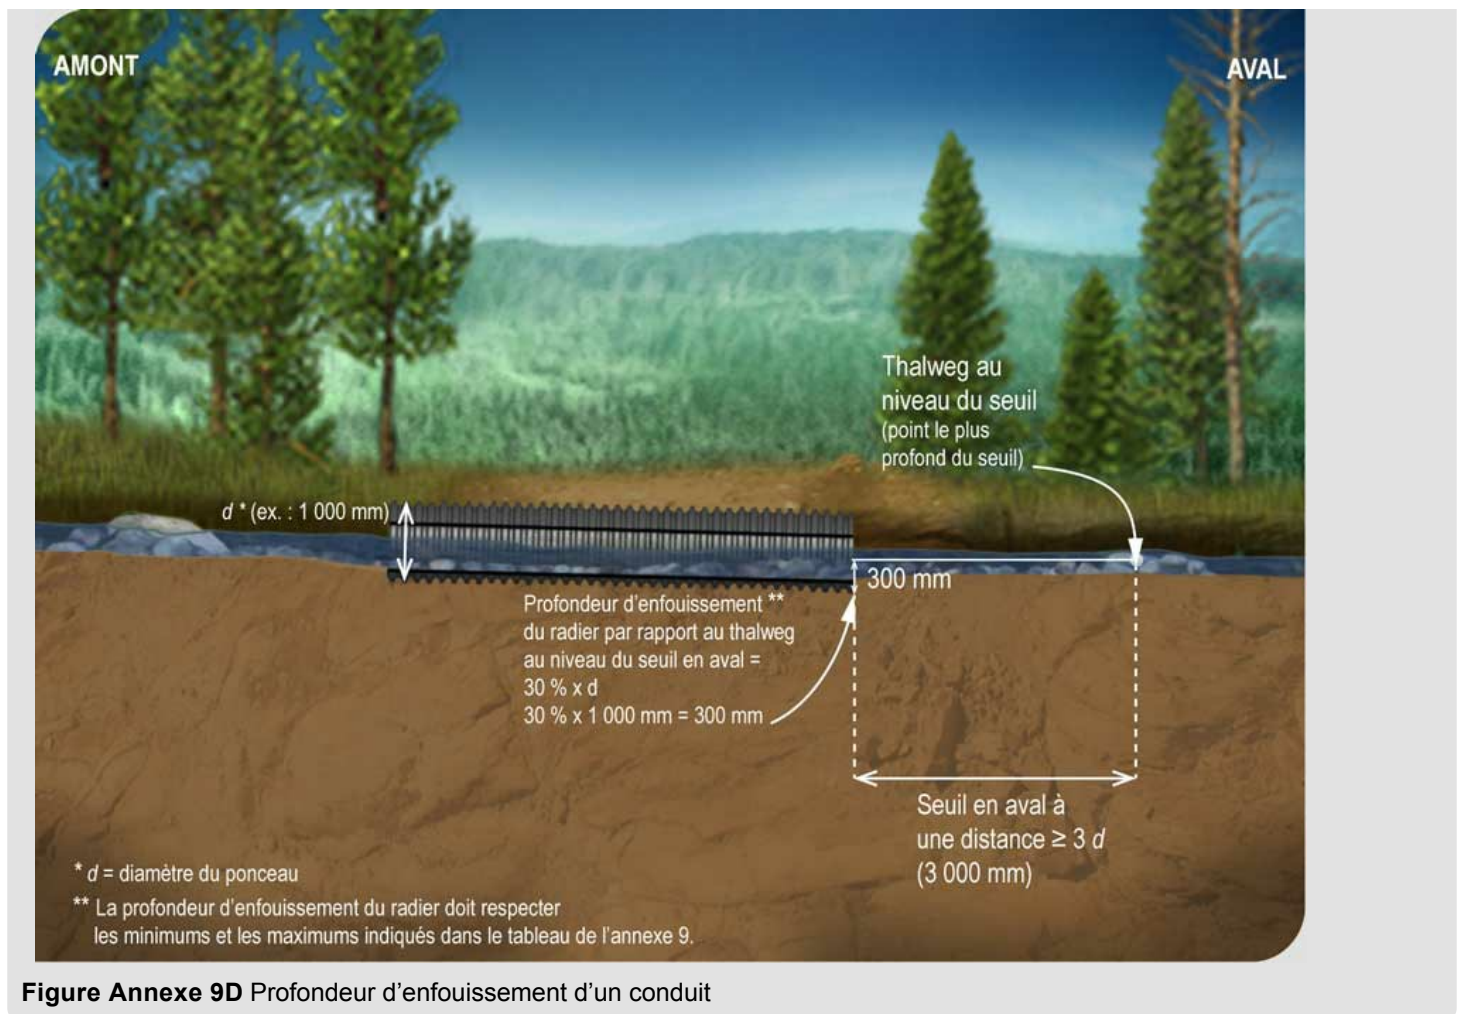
D Profondeur d'enfouissement d'un conduit
